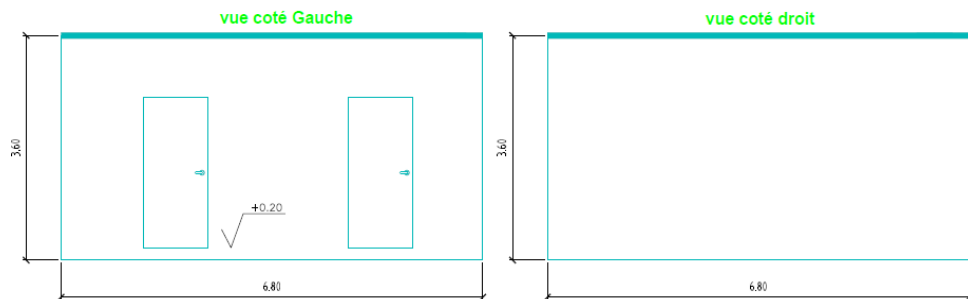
Coupe du bâtiment du poste de Transformation et de livraison (source: REDEN)
